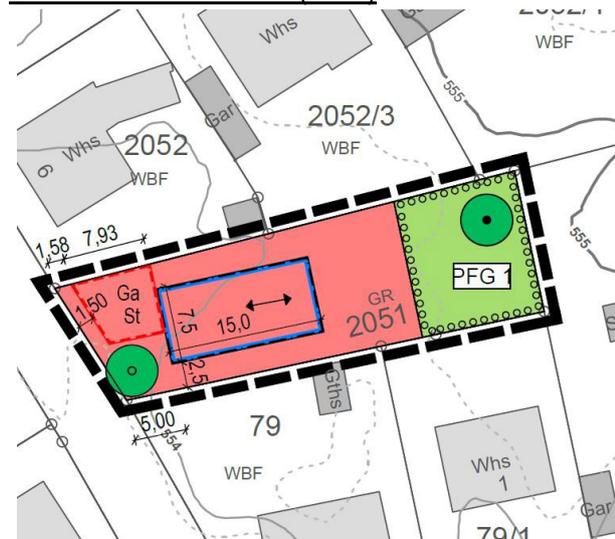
Bebauungsplan „Remsstraße, Flst. Nr. 2051“
